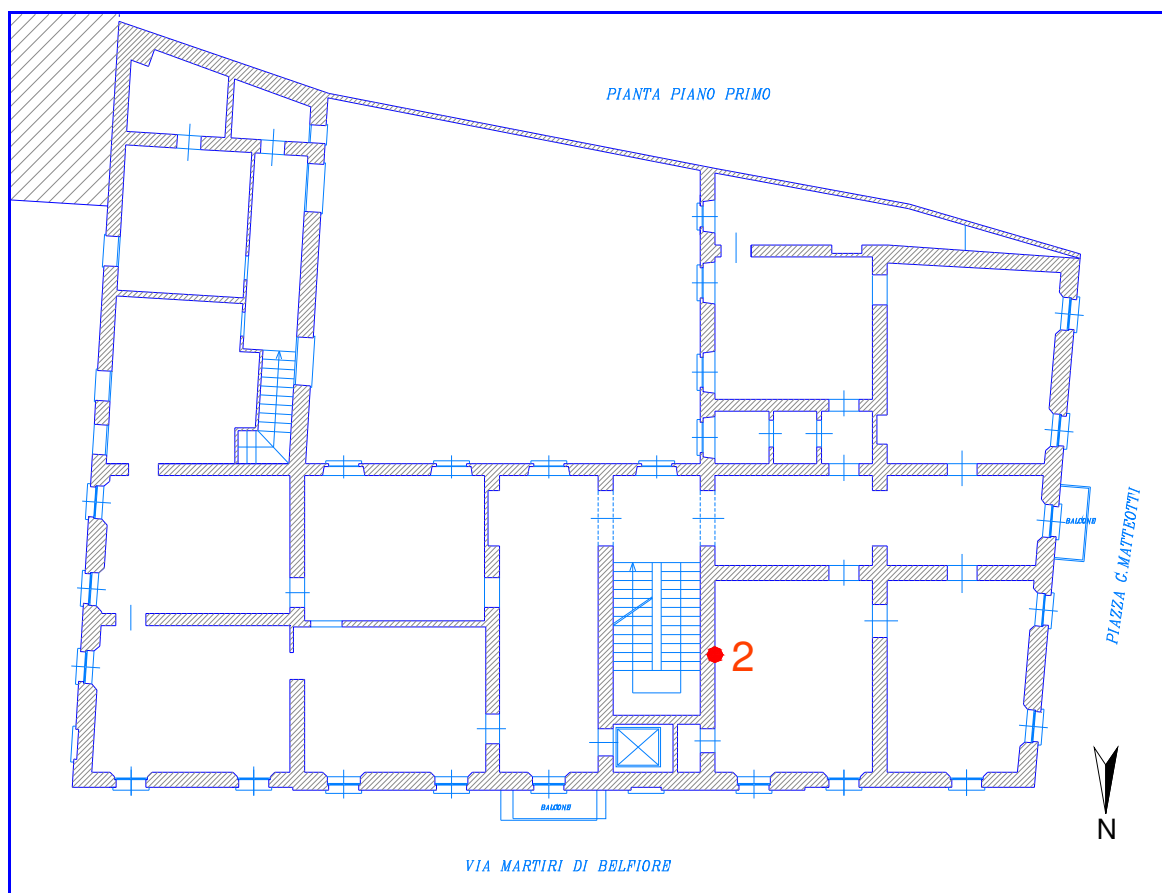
Planimetria del piano primo con ubicazione della zona di prelievo
